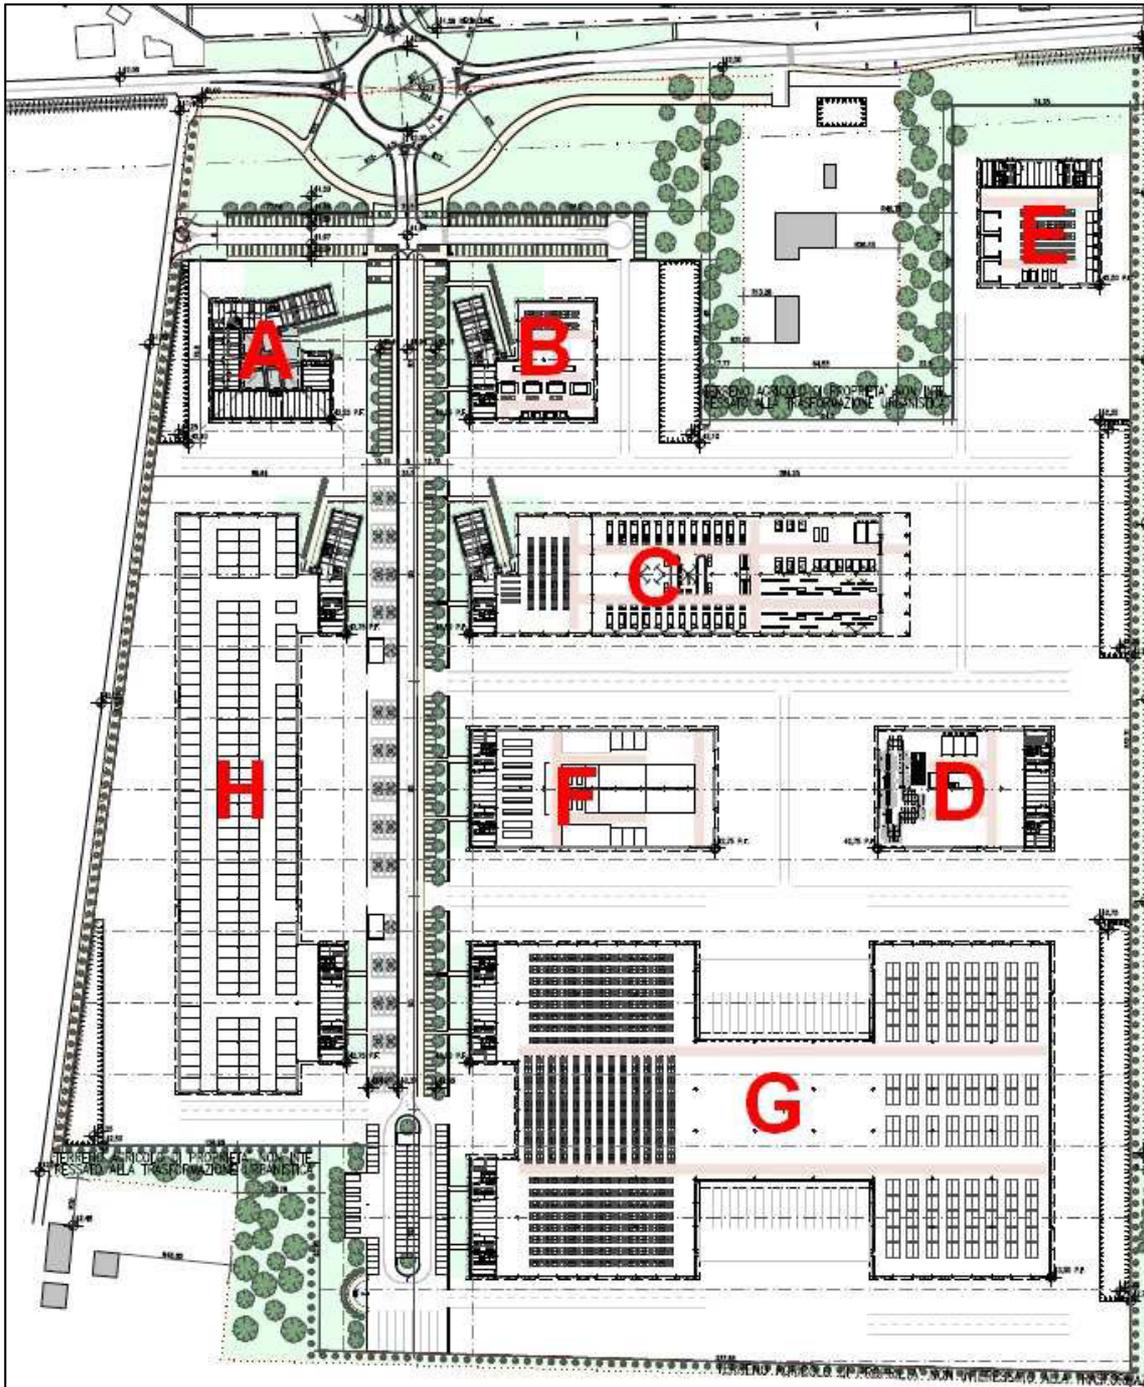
Planimetria generale dello stabilimento con indicazione dei diversi edifici, corrispondenti alle Unità Minime di Intervento
